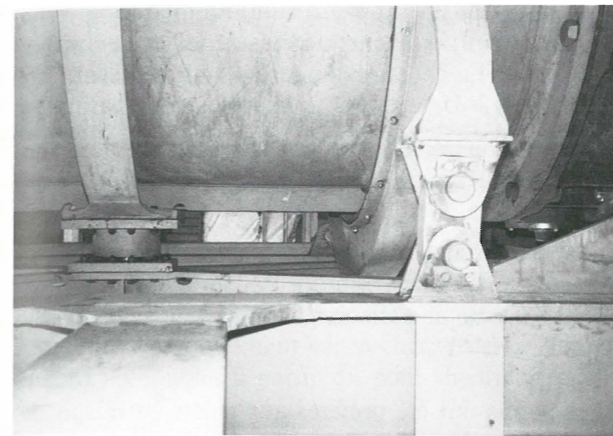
Écluse de Zeebrugge — Porte de flot. Appui de la conduite de remplissage et de vidange du sas.
